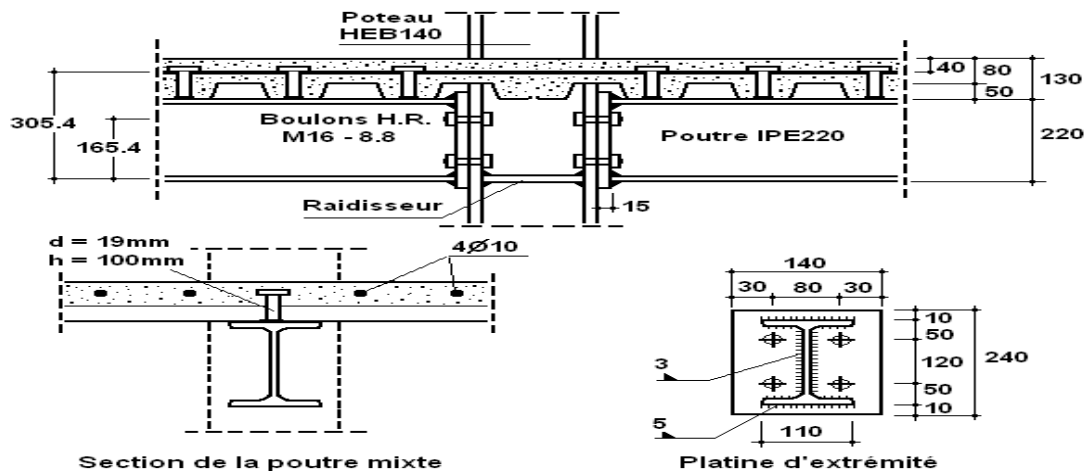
Assemblage mixte poutre-poteau par platine d'extrémité [3].
